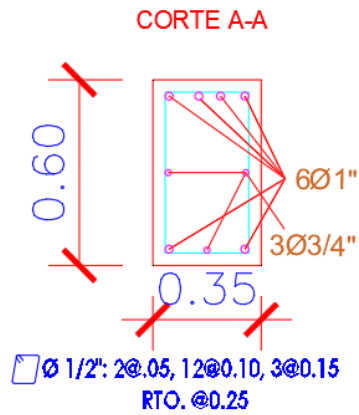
Secciones de Viga con Refuerzo 6° Piso
